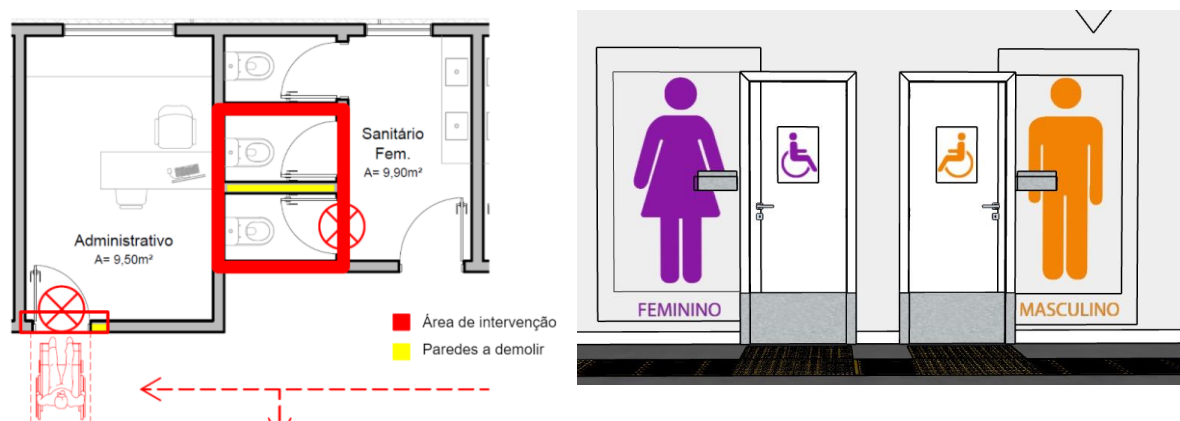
Estudo preliminar para a Distribuidora 01 a partir de planta baixa (esq) e proposta de sinalização para banheiros (dir).
